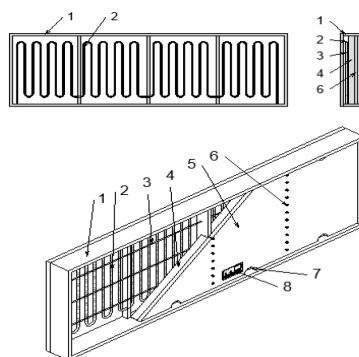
Термоактивная опалубка с трубчатыми нагревательными элементами:
